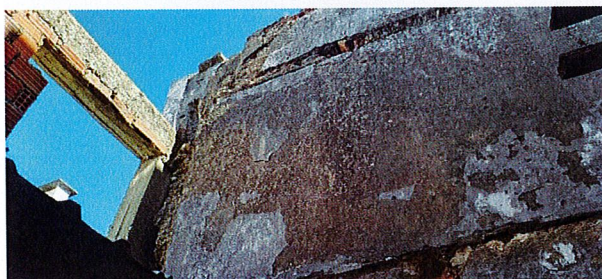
Vista sobre a parede meeira (norte). Ausência de rebocos, potenciando a infiltração de águas e a degradação do paramento
